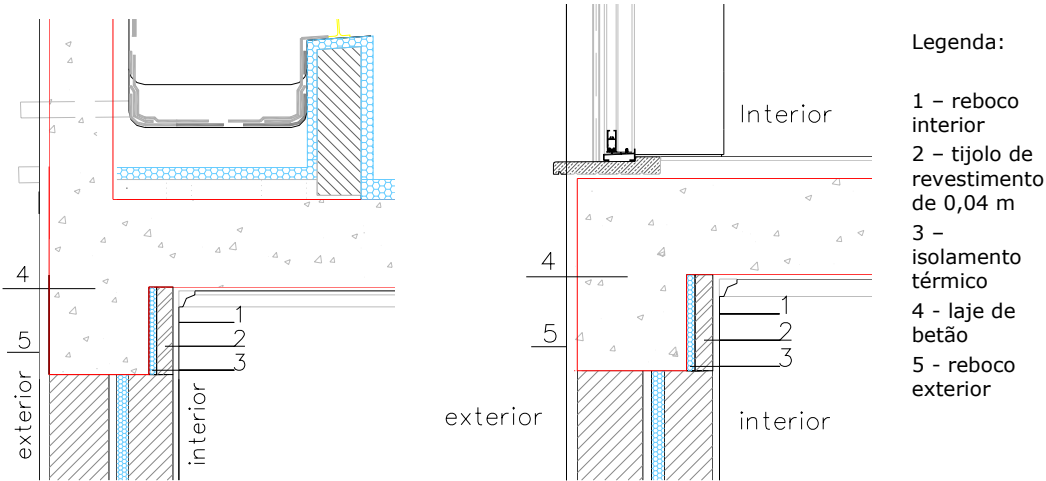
D.5 – Ponte térmica plana - Talão de viga de betão armado da laje de cobertura.
